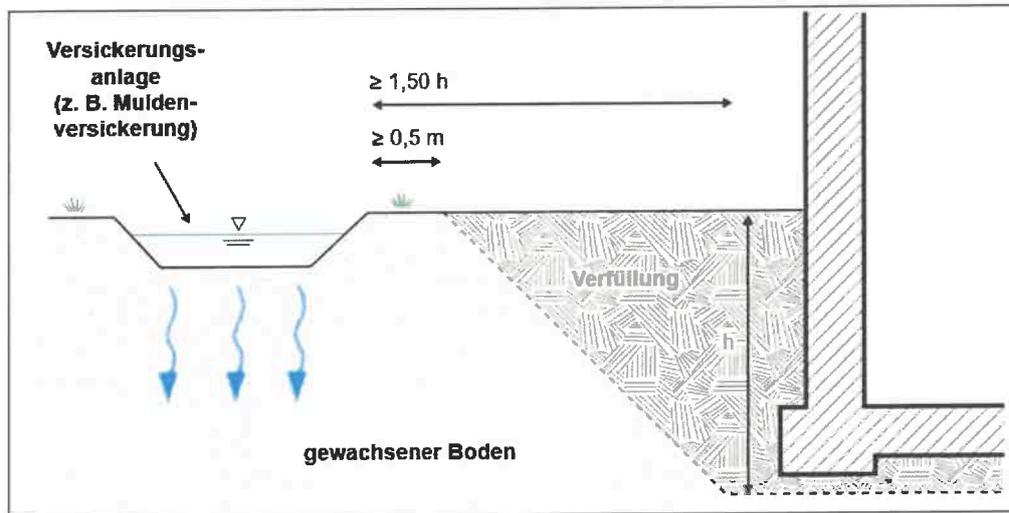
Prinzipskizze Bauwerksabstand dezentraler Versickerungsanlagen [L 16]
